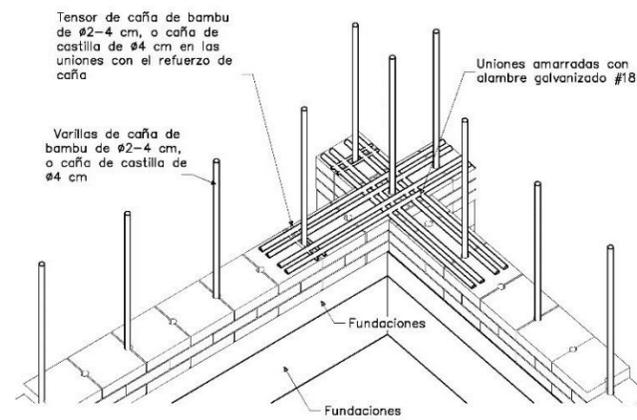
Detalle de unión en esquina. Fuente: equipo de trabajo
